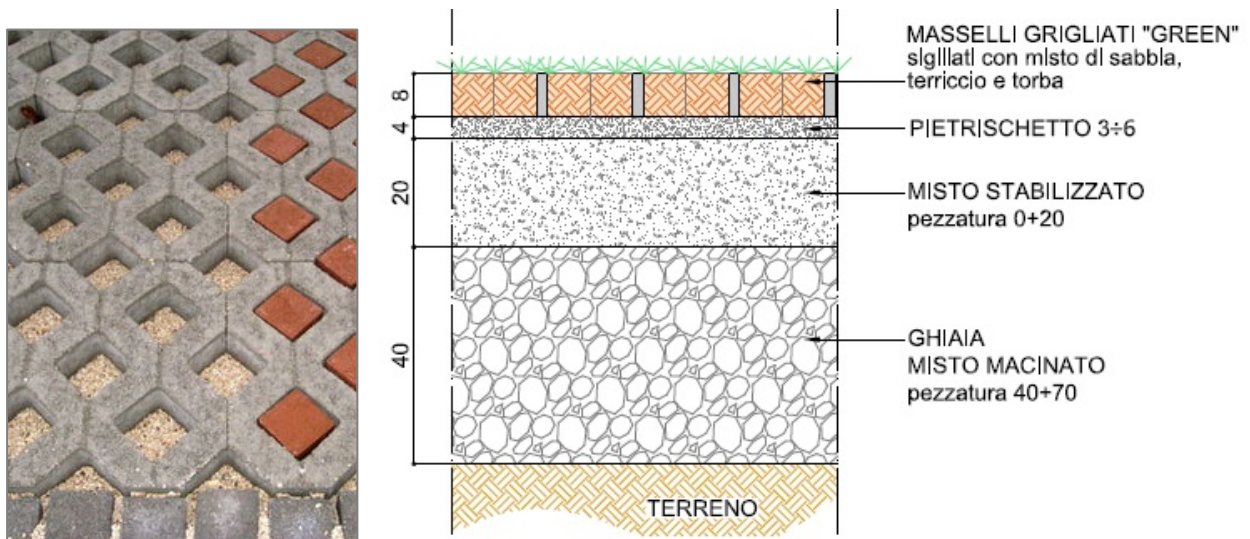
Pacchetto tipologico della pavimentazione in "green" ed esempio di masselli in calcestruzzo
